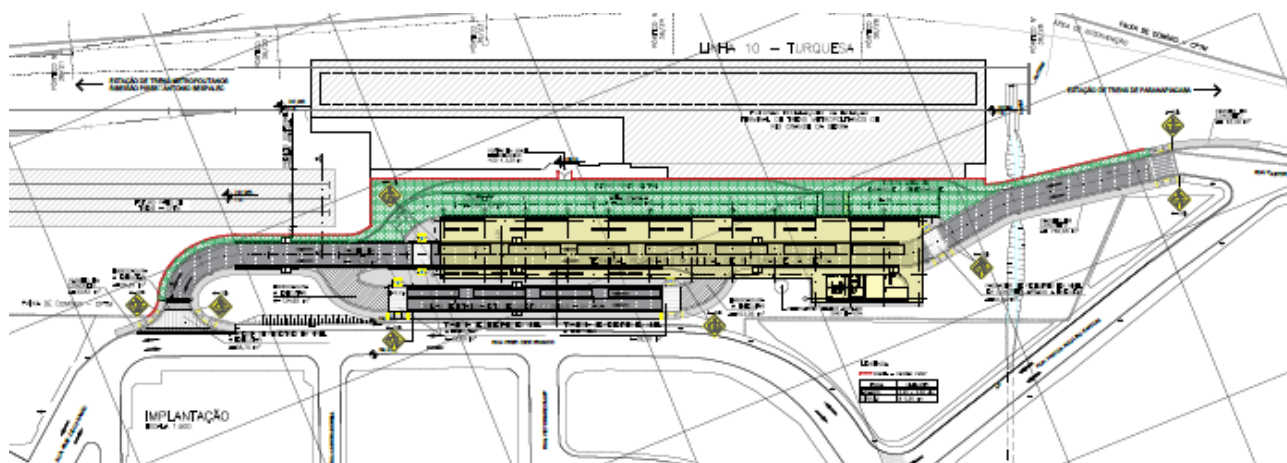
Implantação do Terminal Rodoviário. Fonte: Secretaria de Obras e Planejamento, 2021.
